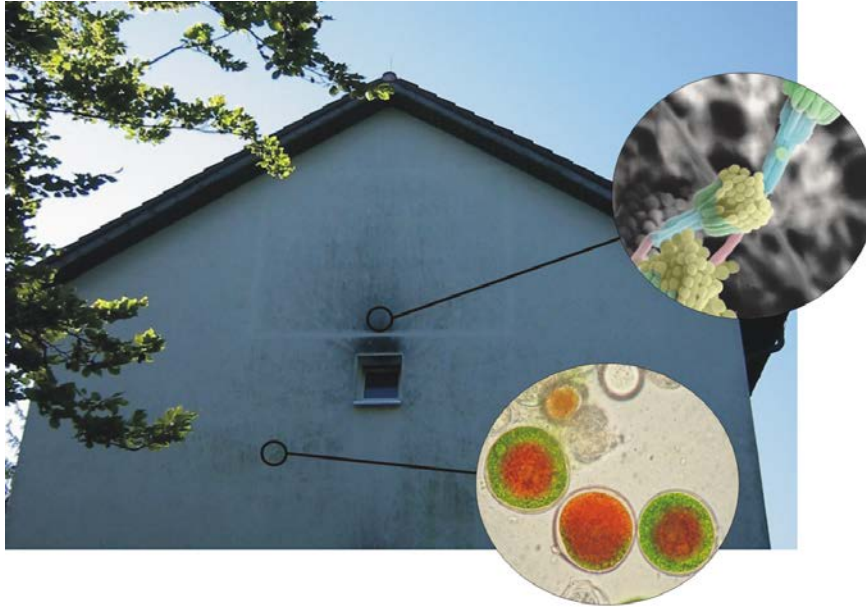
Algenbewuchs einer Fassade mit Wärmedämmverbundsystem und Schimmelpilzbewuchs oberhalb eines Fensters.
